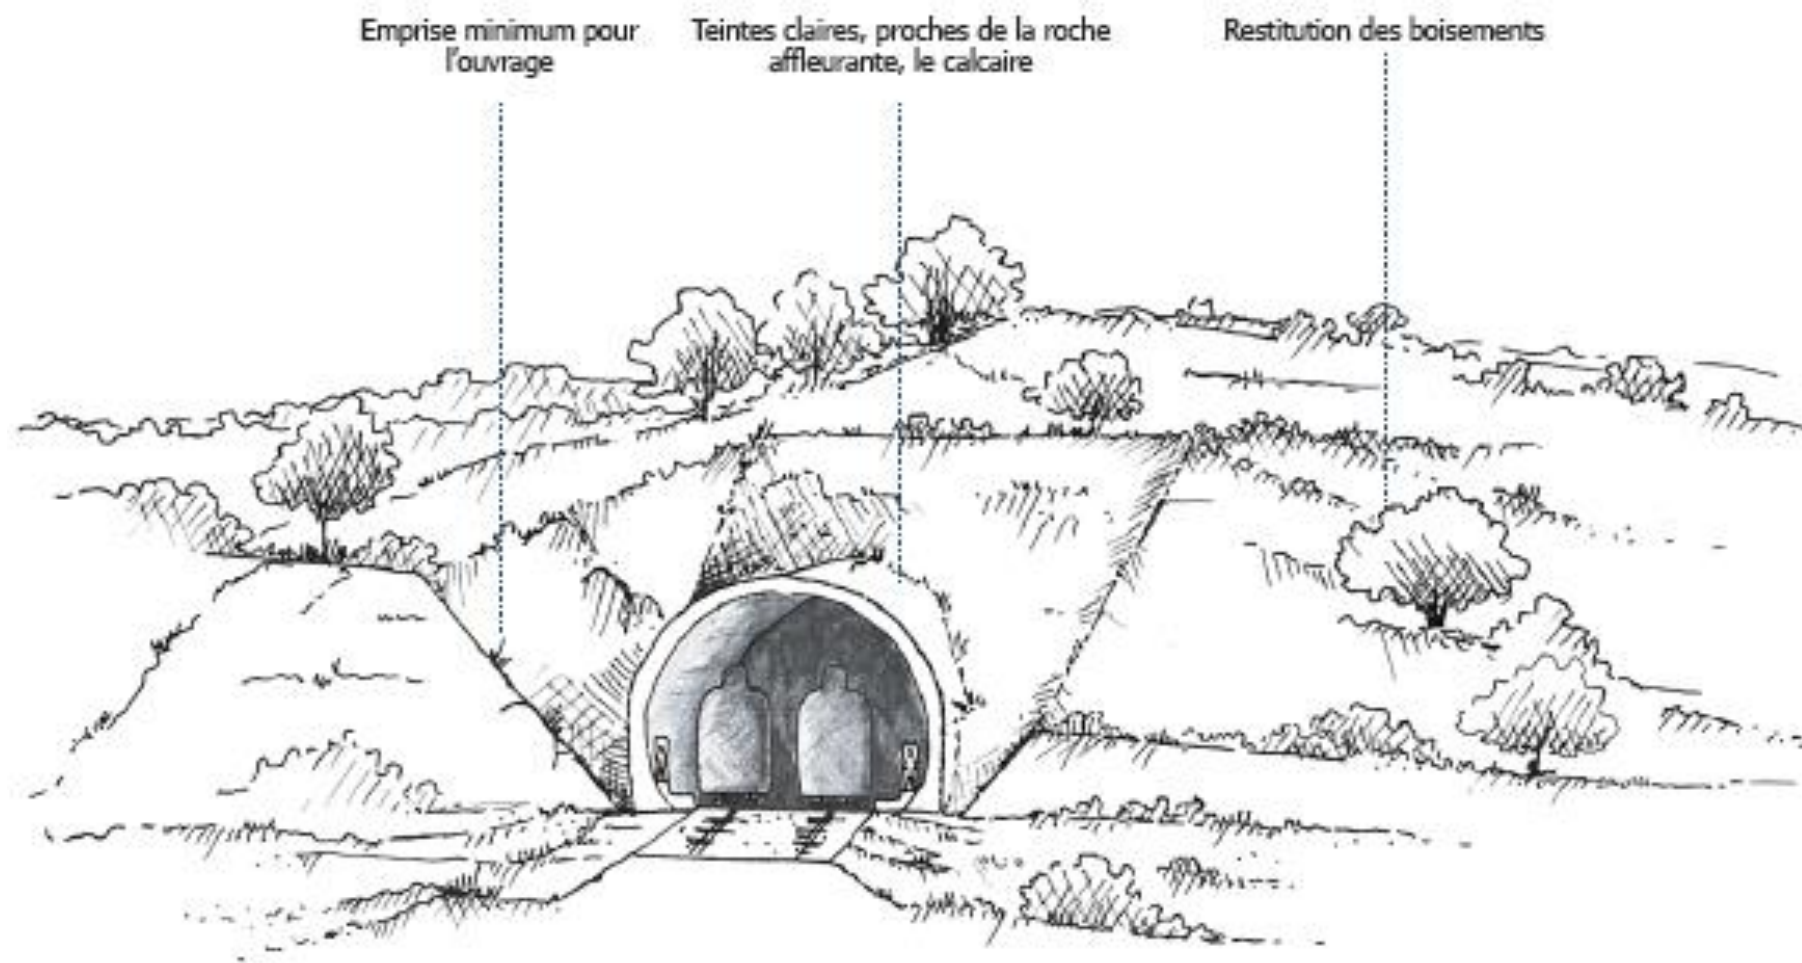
croquis d'une tête de tunnel qui se fond dans la végétation, l'esquisse du tunnel de la Gardiole depuis l'Est (source : Ingerop)
